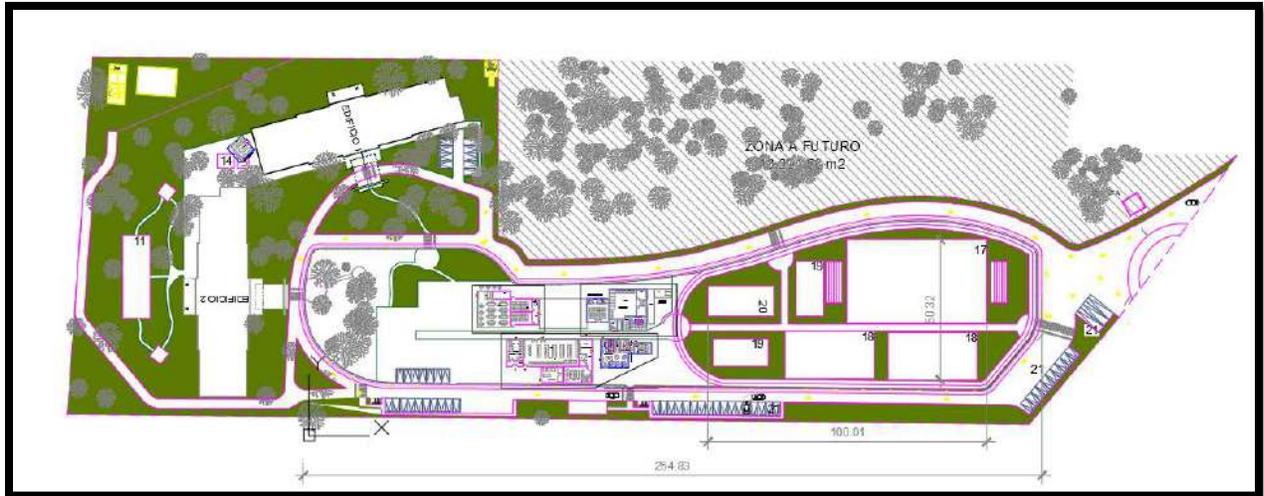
Master Plan. La Paleta. Fuente LabColectivo
